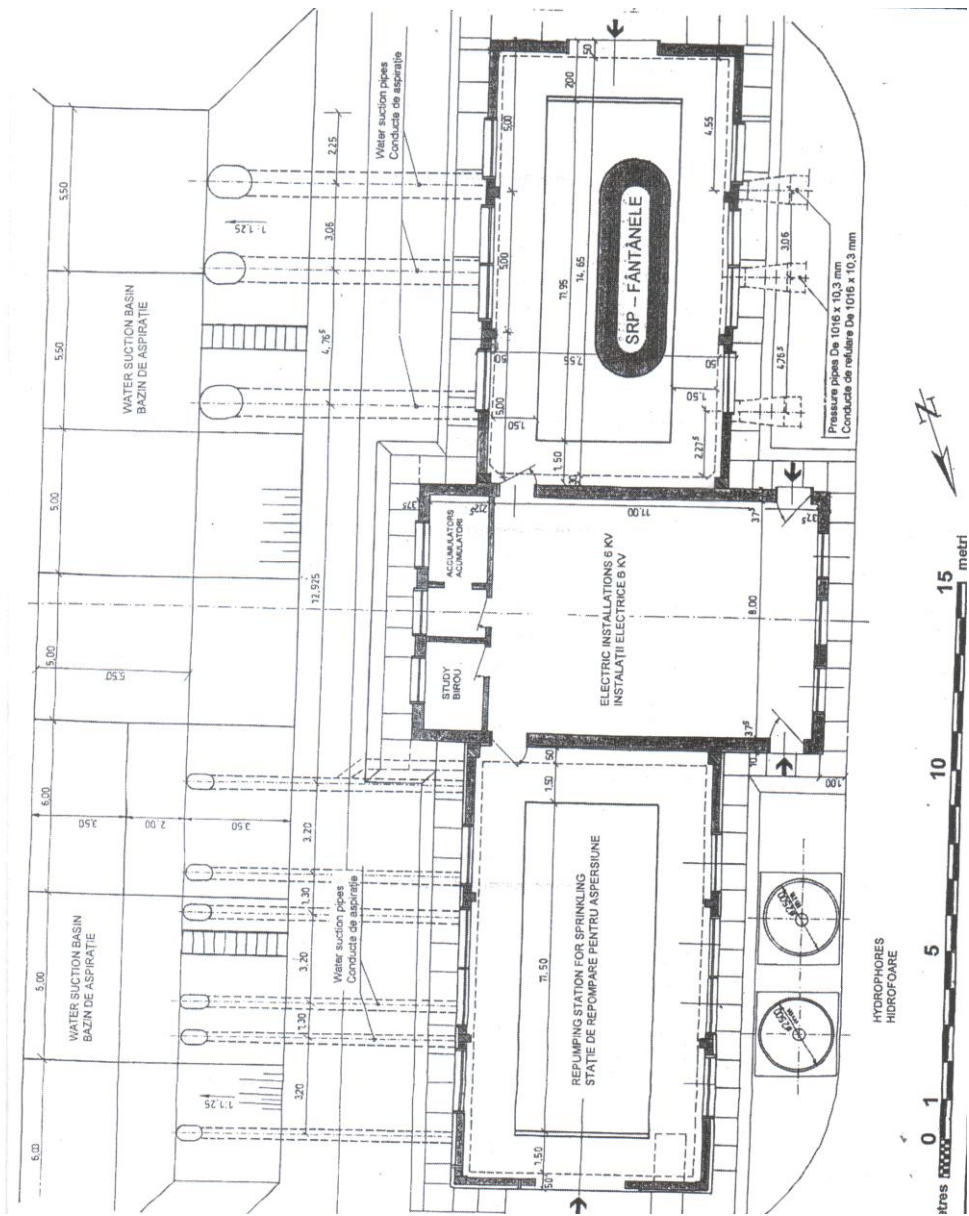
PLAN DETALIU – AMPLASARE LUCRARI (FILA 2) (S.R.P.) [102]
